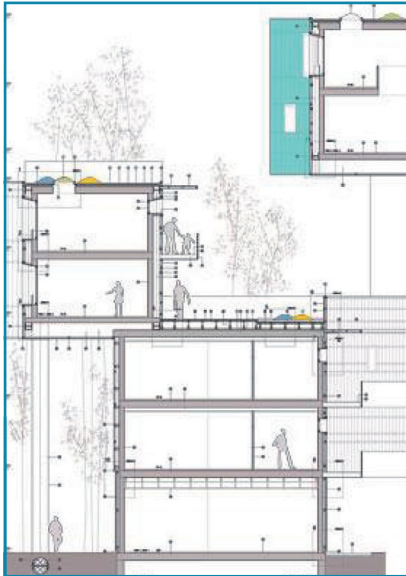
Plano de sección del estudio de la tipología de vivienda, 2003.
